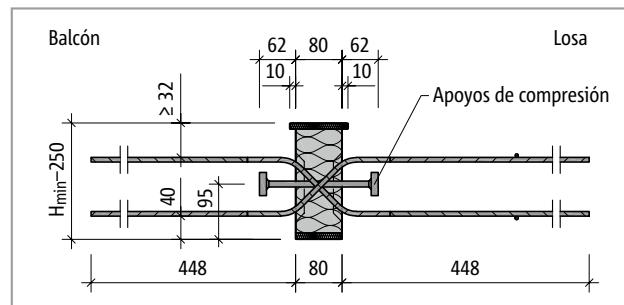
Schöck Isokorb® T tipo Q-P-VV1 hasta Q-P-VV3: Sección del producto
